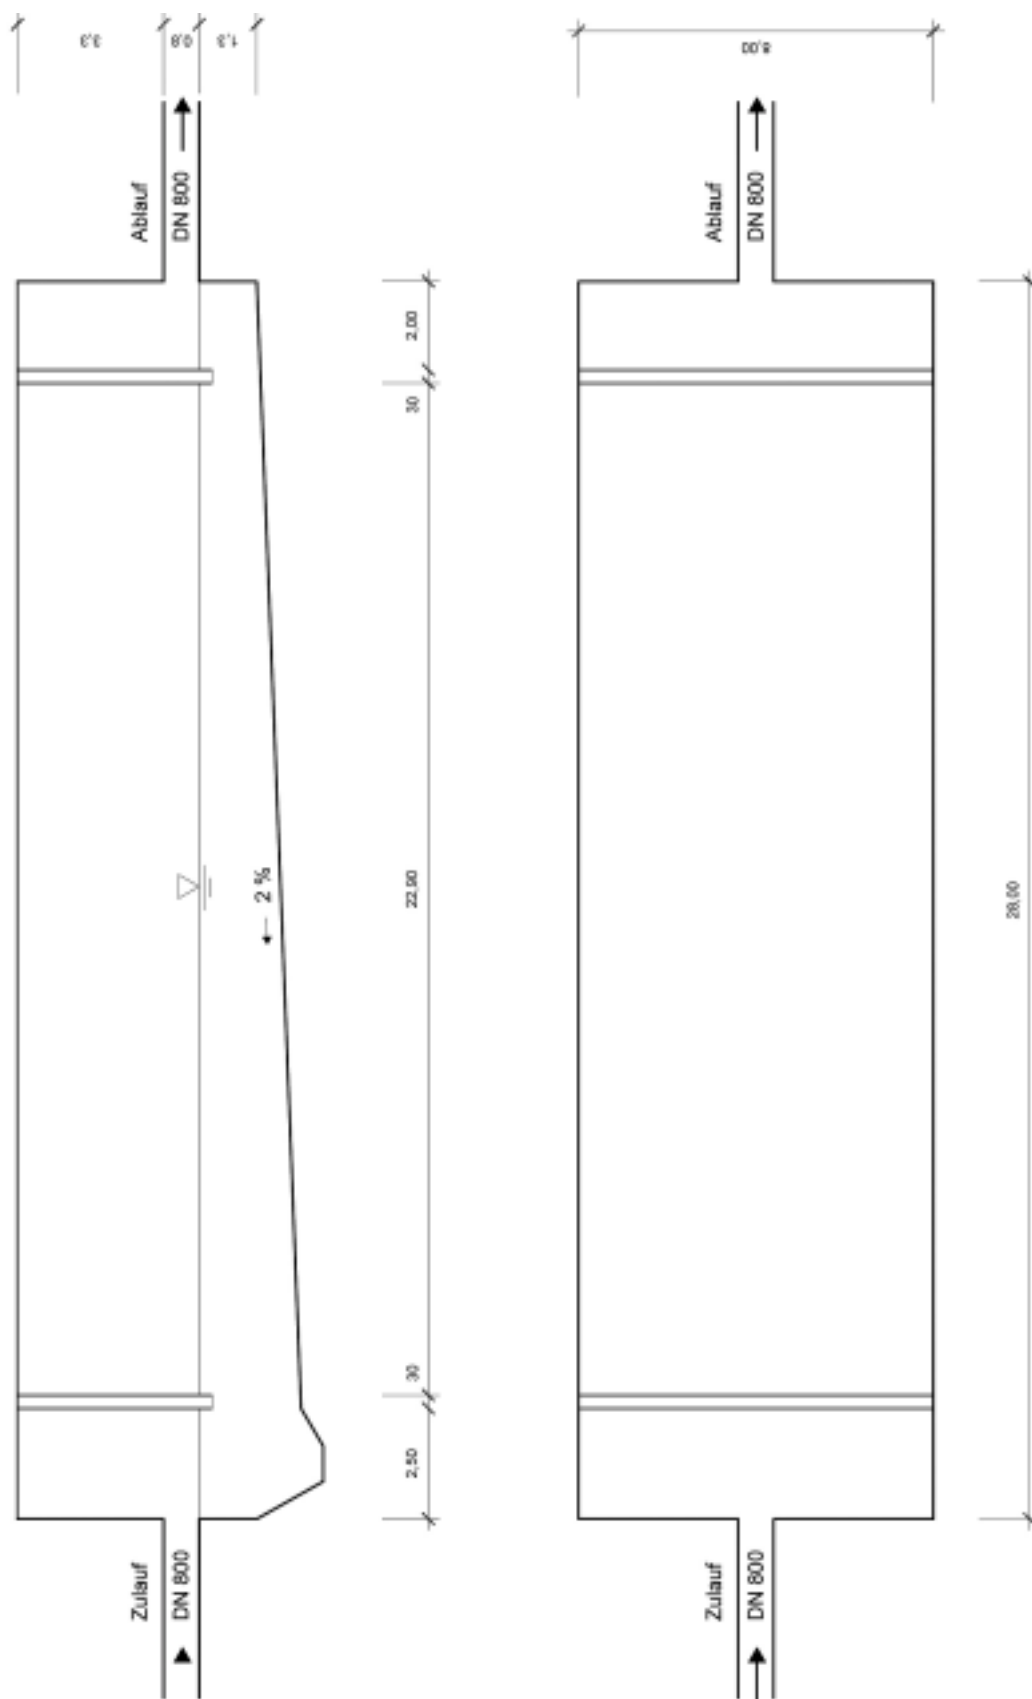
Draufsicht und Schnitt Becken Westhover Weg
